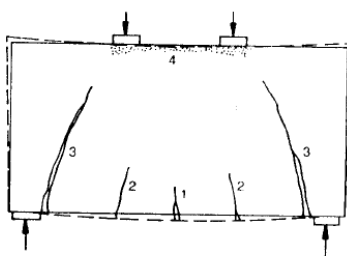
Ruptura por flexão-cisalhamento em vigas biapoiadas (SANTOS, 1999).
